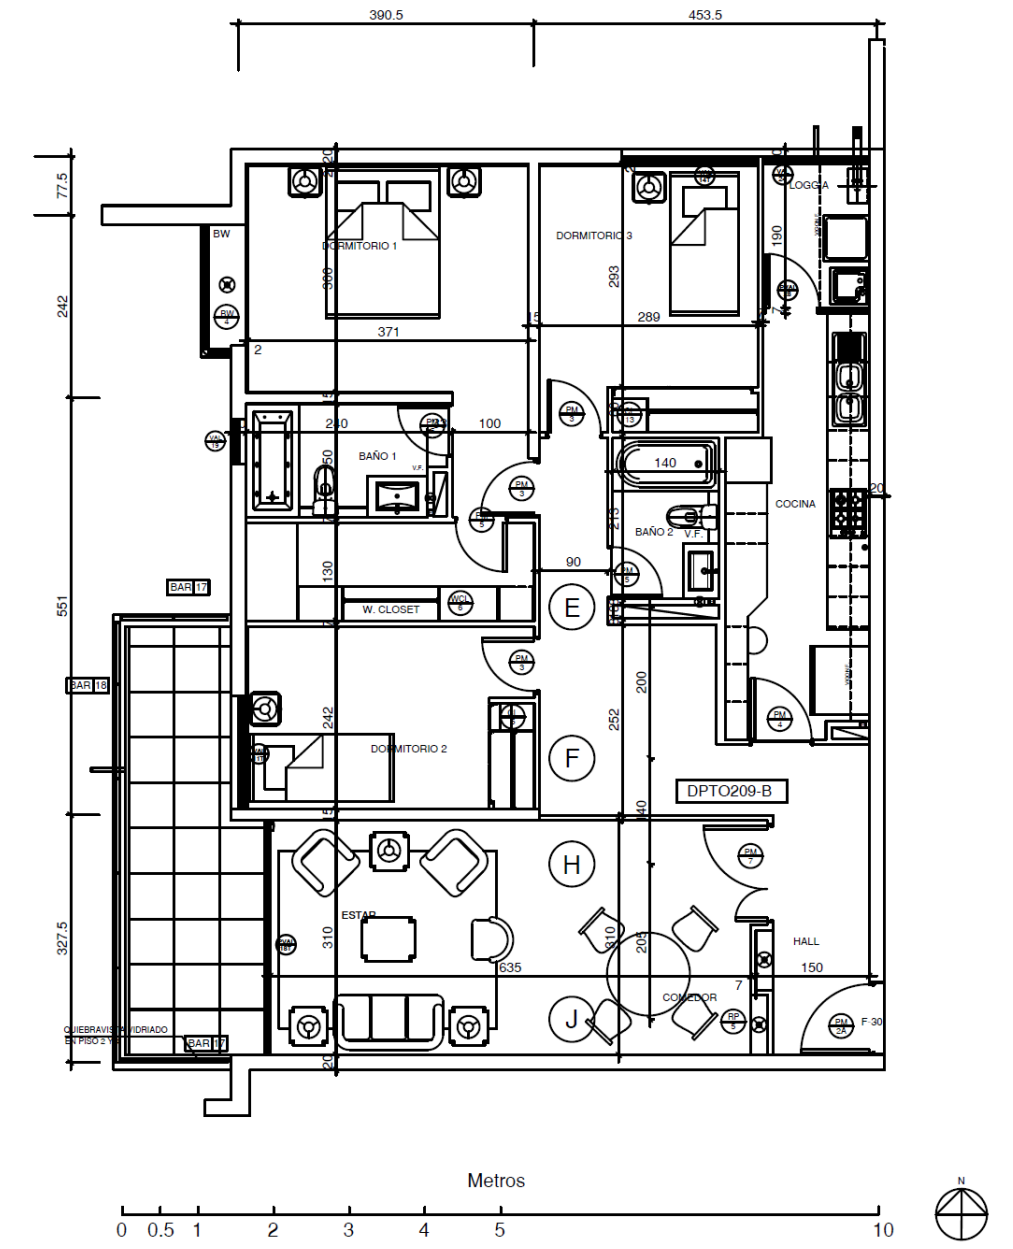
Planta tipo departamento 3 dormitorios y 2 baños. (Fuente: elaboración propia)
